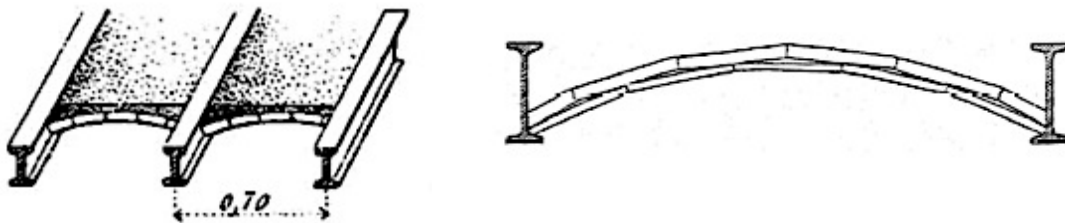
Aplicação da técnica da *abobadilha* entre vigas de ferro [29]
